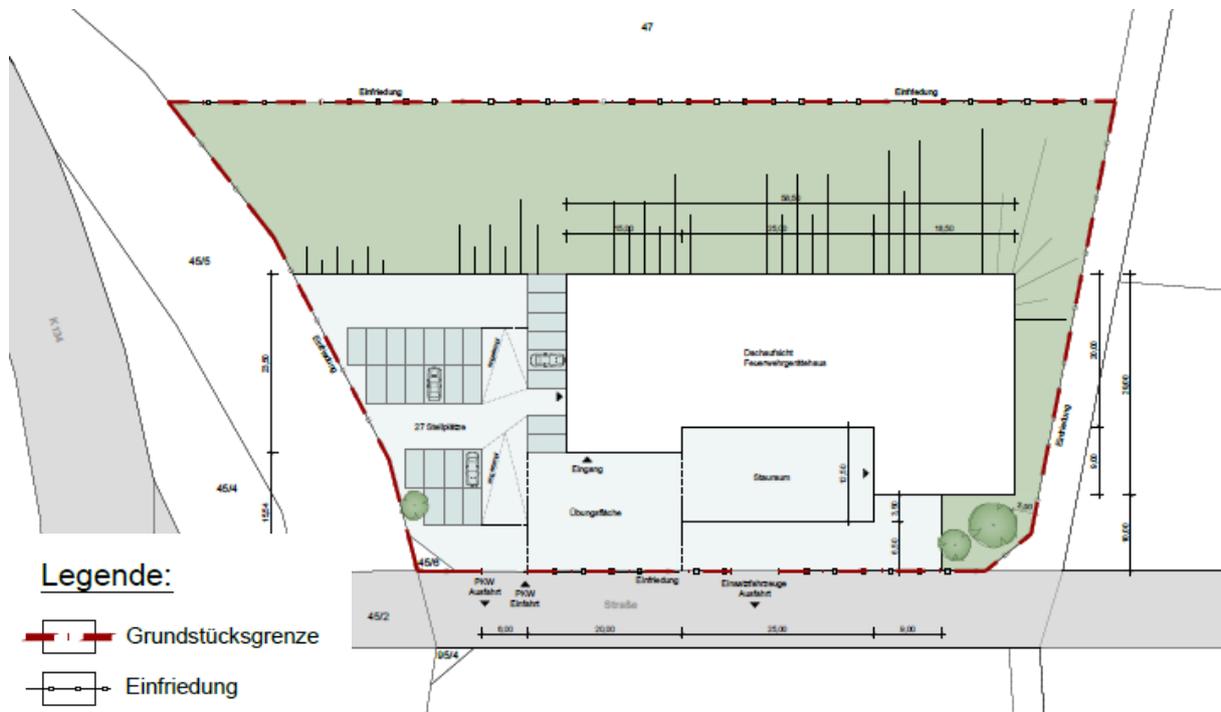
Planungskonzeption (Quelle: Planen & Bauen GmbH,
